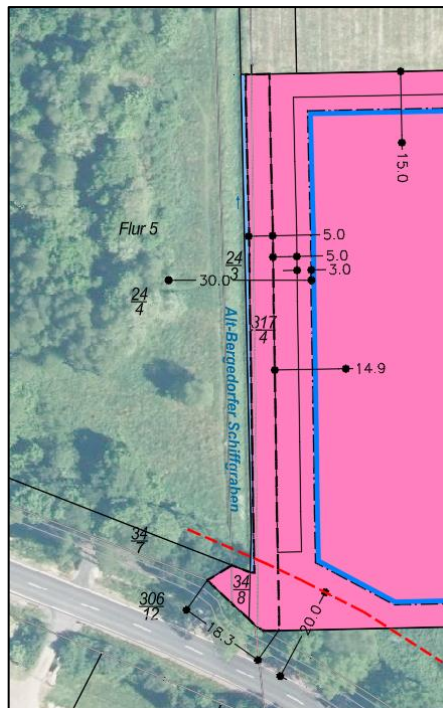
Ausschnitt aus dem georeferenzierten Orthofoto überlagert durch die Planzeichnung (Quelle: LGLN und Instara, 2025)
